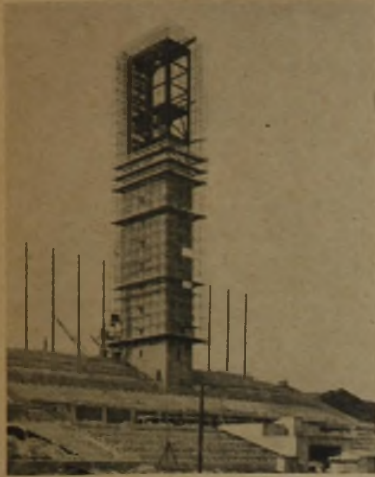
Tribünenturm mit Stahlrohrgerüst
